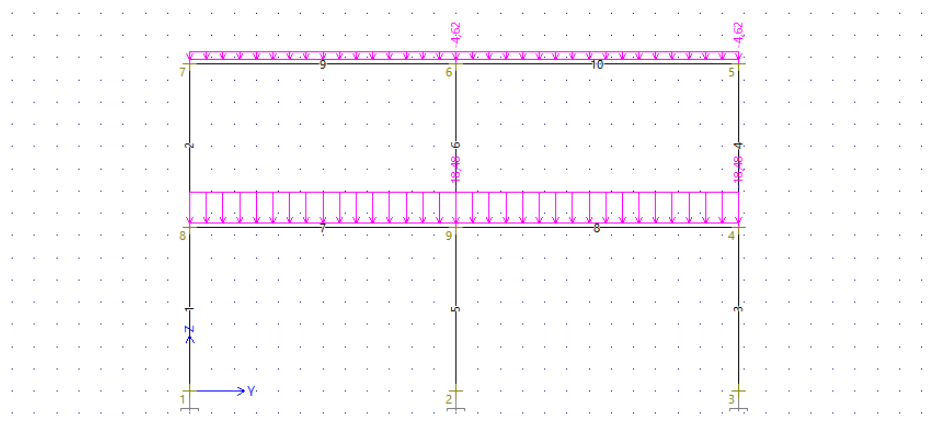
ZS1 - zatížení konstrukce vlastní tíhou (sloup)
